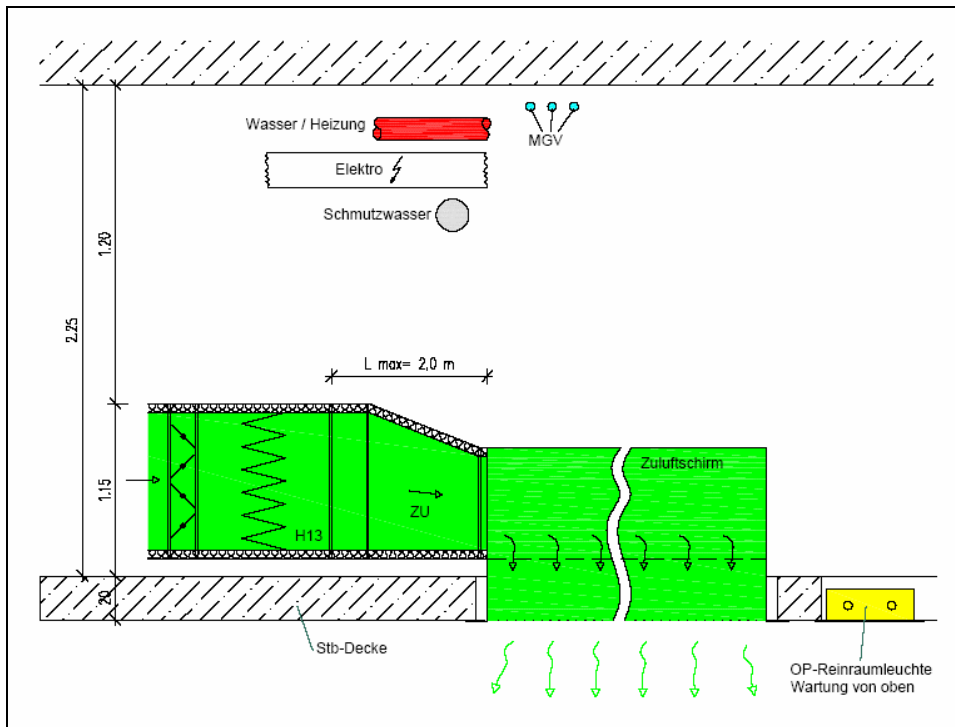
/4: OP-Raum mit Stahlbeton-Zwischendecke
